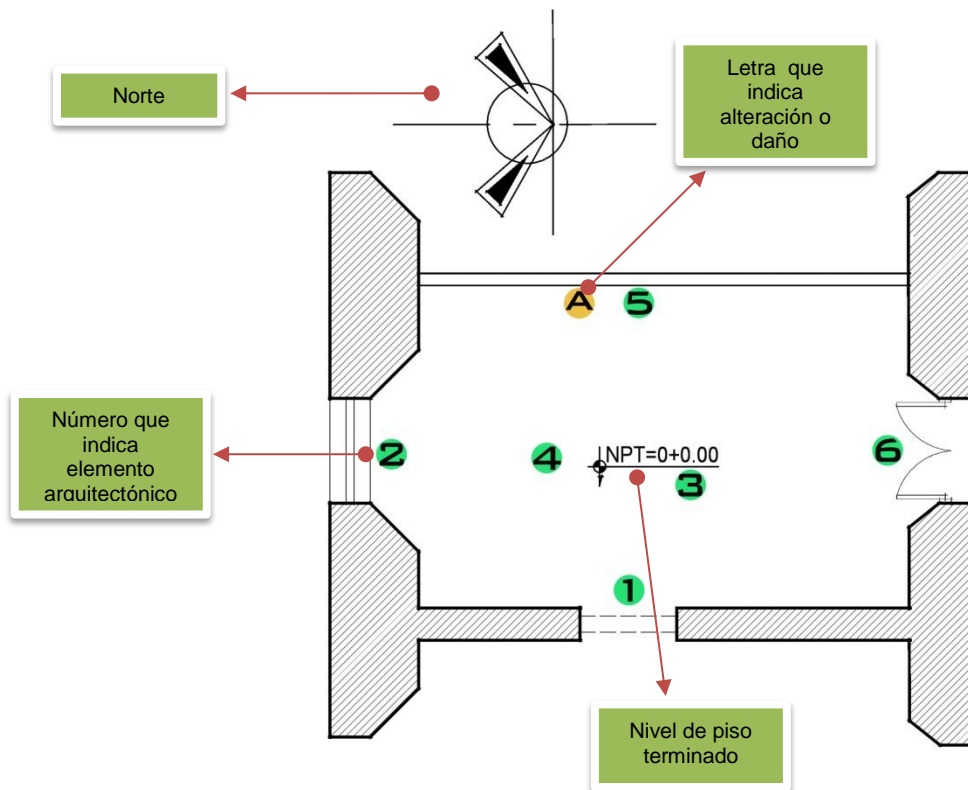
Contenido para la planta arquitectónica actual de cada espacio.
